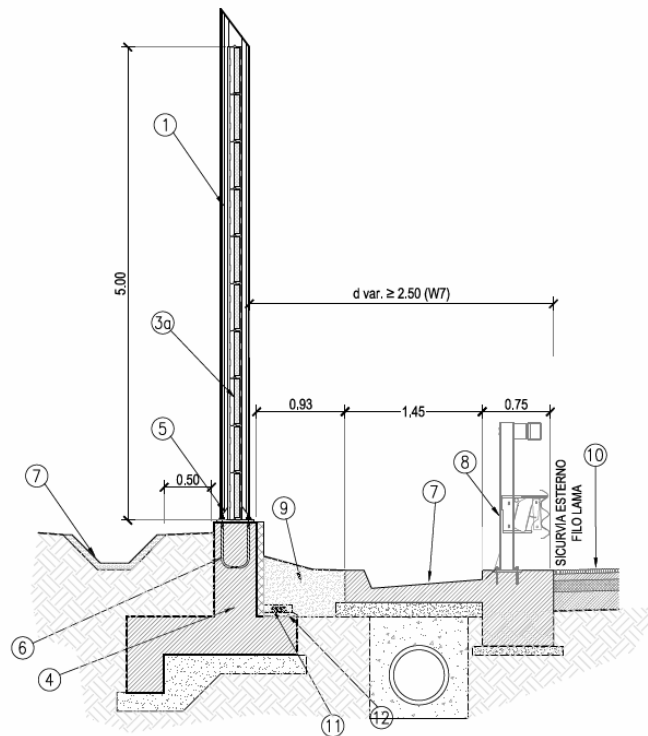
Pannello trasparente in PMMA: sezione tipo in rilievo
